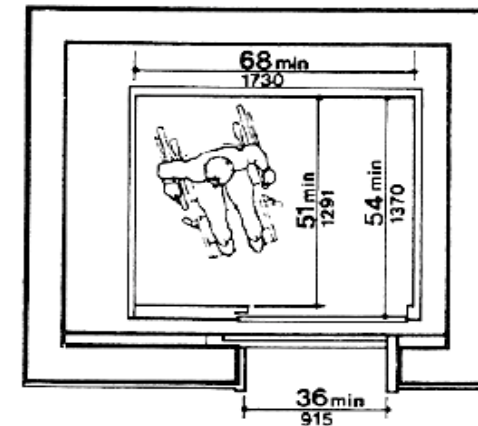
Dimensiones mínimas para cajas de elevadores. Fuente Op.Cit. pp.34
